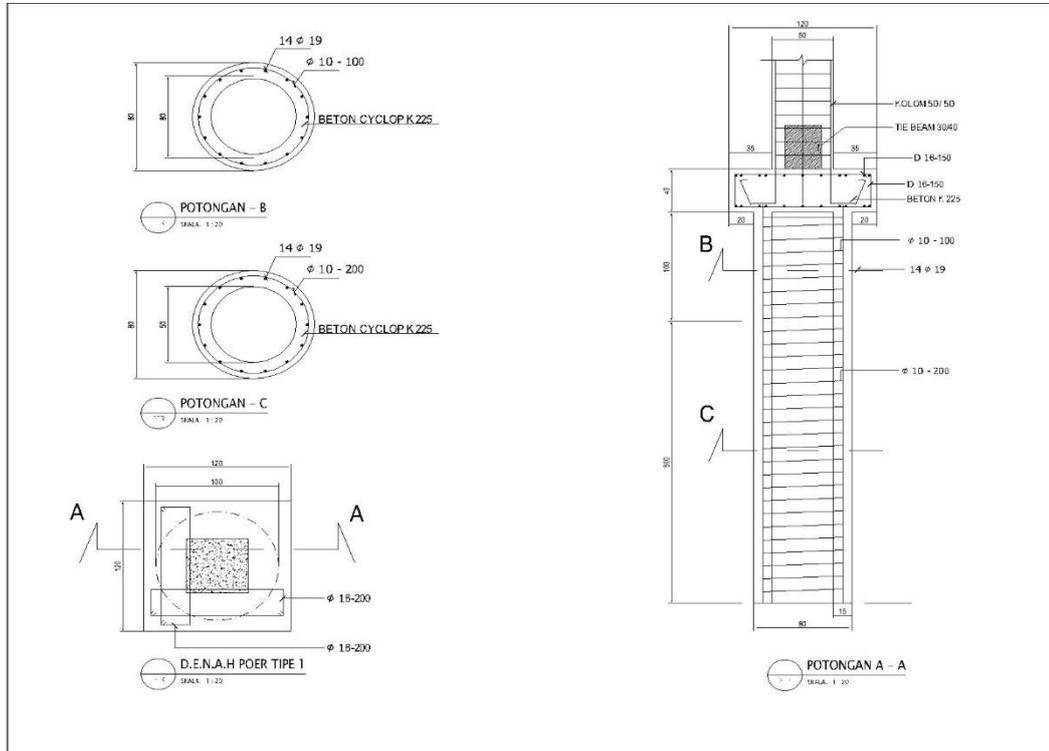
Detail Pondasi Sumuran Tipe 1
